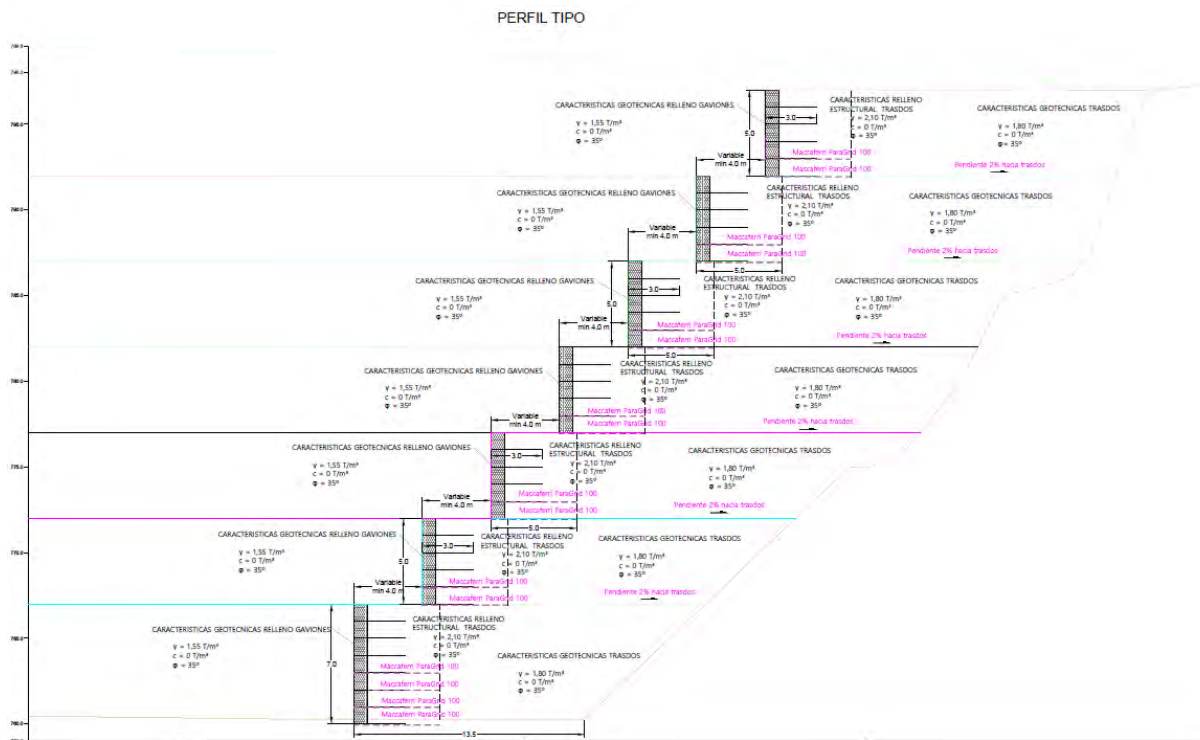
Perfil de muro de gaviones para la situación de mayor altura de gaviones en extremo sureste.
